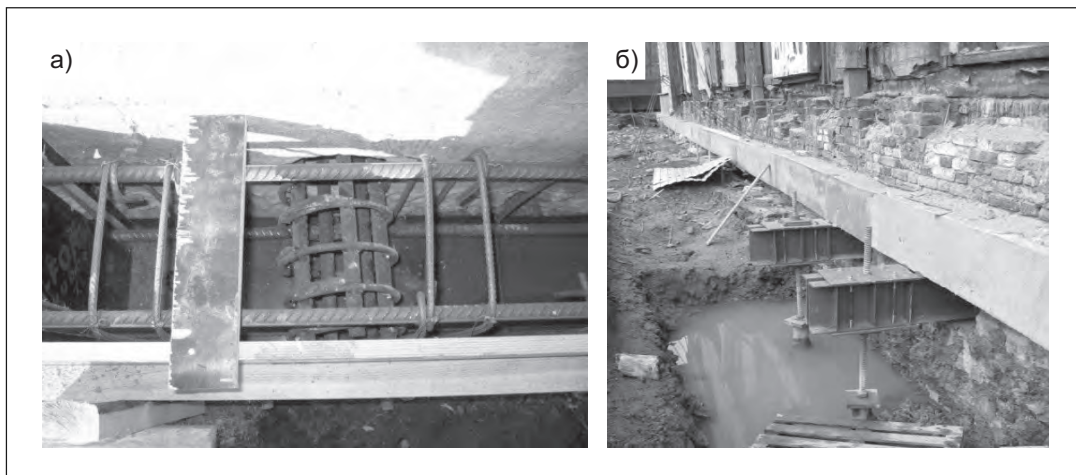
Устройство обвязочного пояса: армирование, подведение балок под обвязочный пояс и передача нагрузки на сваю
